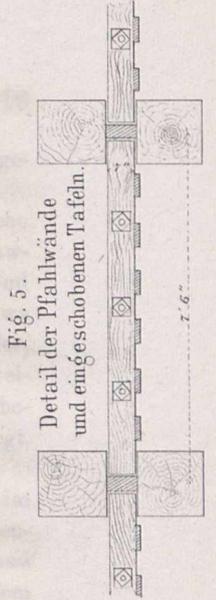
Detail der Pfahlwände und eingeschobenen Tafeln.
